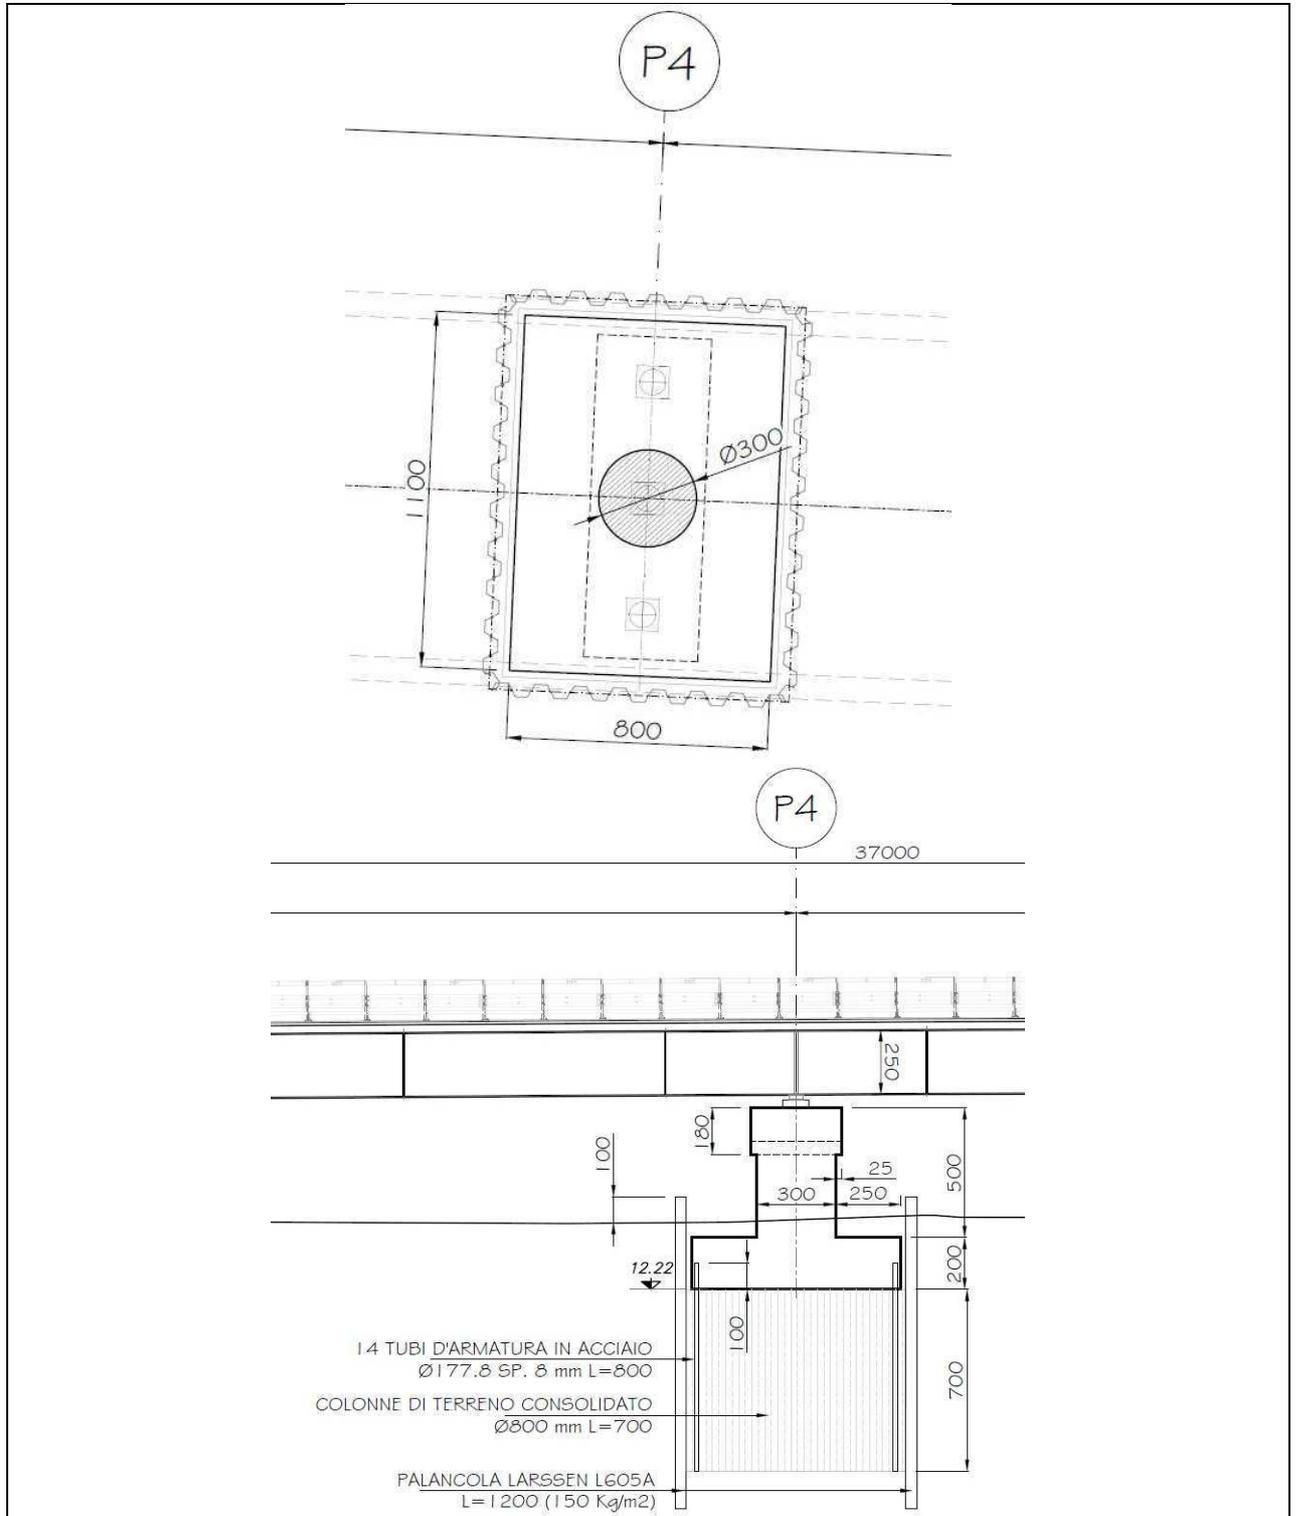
Pila4 - Pianta Fondazioni e Sezione
